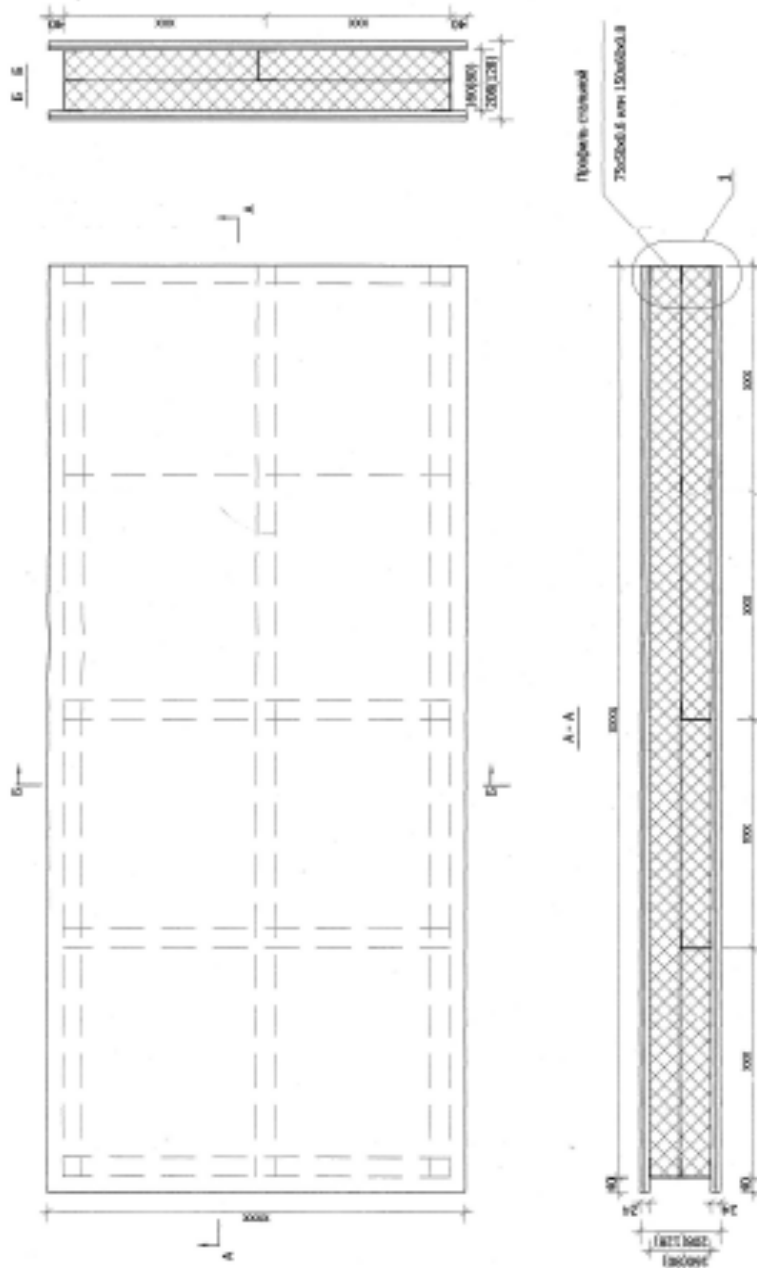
Вариант панельного решения стены (перегородки) с каркасом на стальном профиле
